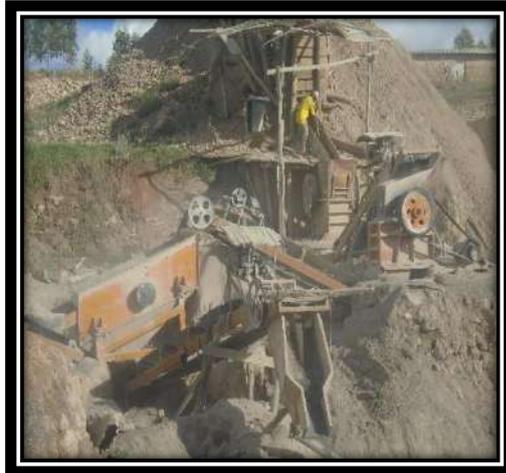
La chancadora de piedra de la cantera Cashacongá.
